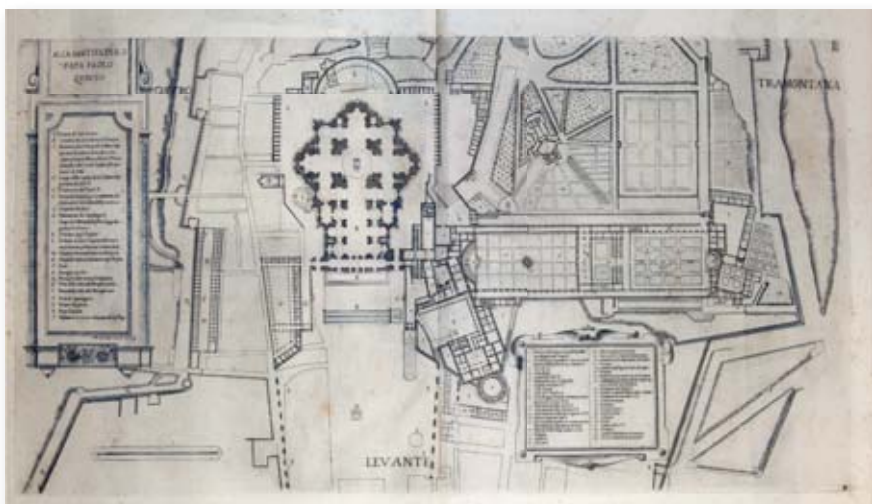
(a fronte) - Planimetria dell'area compresa tra Castel S. Angelo e la basilica di S. Pietro (BAV, Nat. Lat., 11257). Dettaglio dell'area antistante la basilica di S. Pietro
